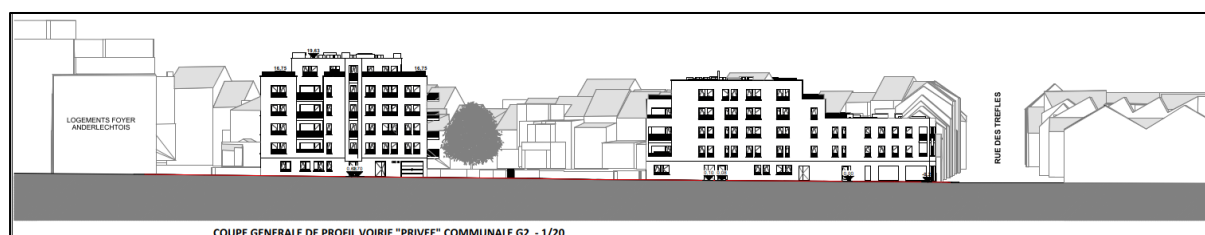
Coupe générale Gabarit G2 - 1/200 (source : Plans PU)
